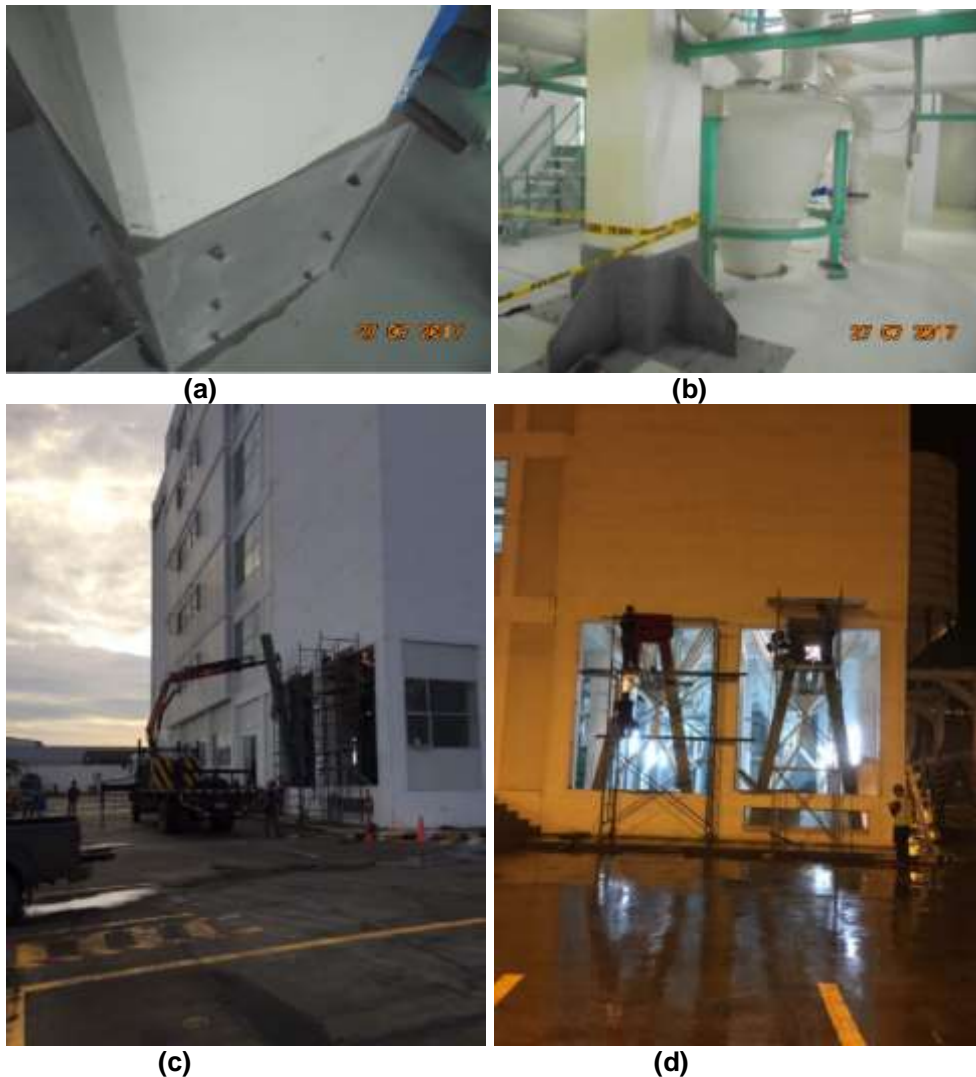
Reforzamiento de Bloques Estructurales de Empresa Molinos Superior de la ciudad de Manta, afectada por el terremoto de 2016 ($M=7.8$); a) Collarin alrededor de la columna; b) Placa Gusset y de continuidad horizontal; c) Ingreso de columna de 5 m, de altura; d) Soldadura en conexiones de vano reforzado con diagonales.
